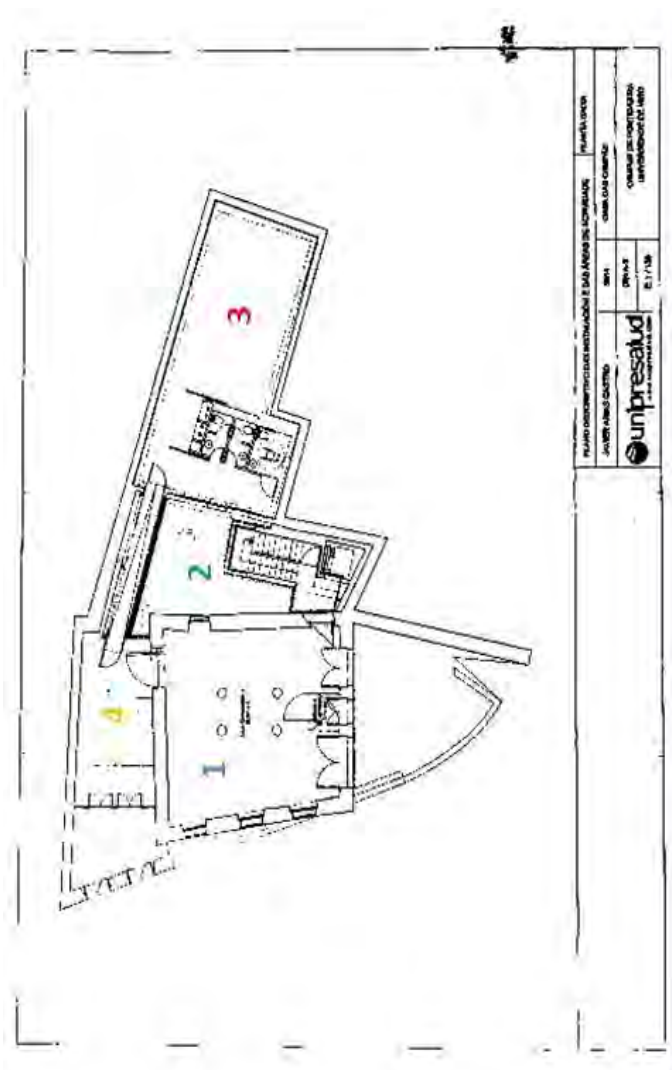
Arias Castro, J., Plano de la planta baja de la actual Casa das Campás/Vicerrectoría del Campus de Pontevedra. Facilitado por la propia institución. 2014.
